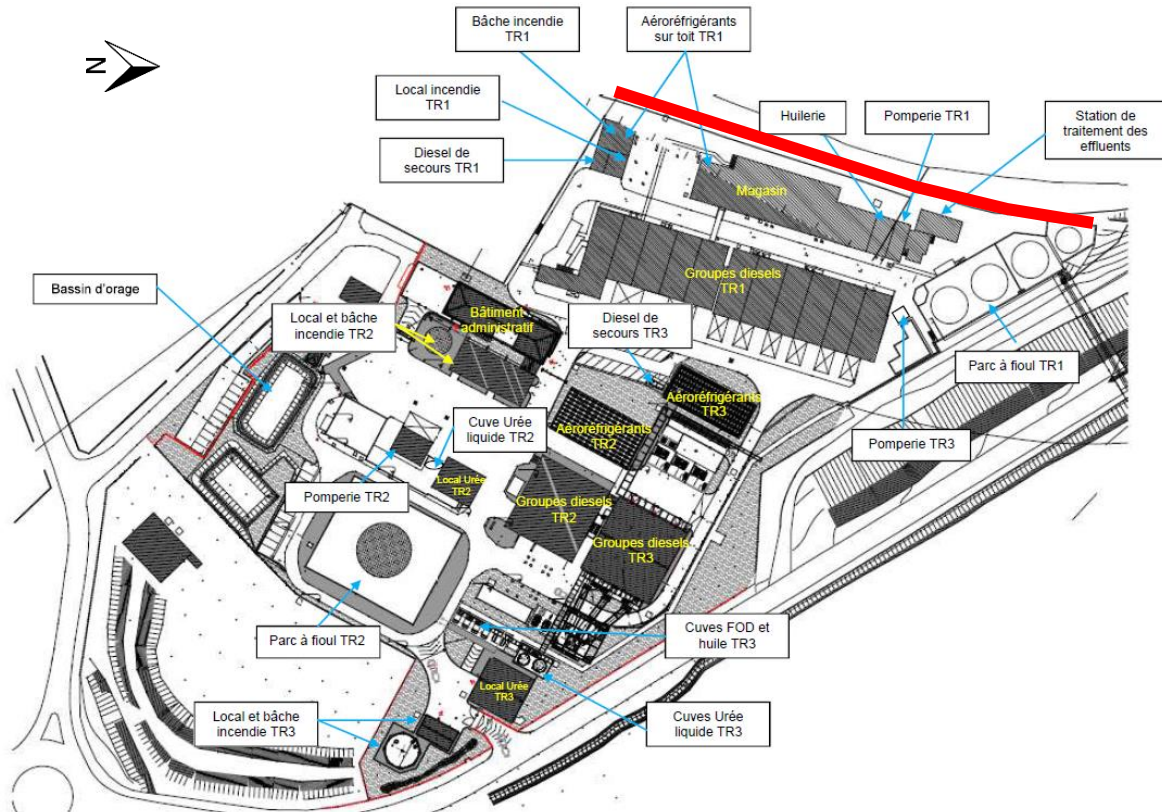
Plan masse du site (ouvrage concerné par le présent projet repéré par un trait rouge)
